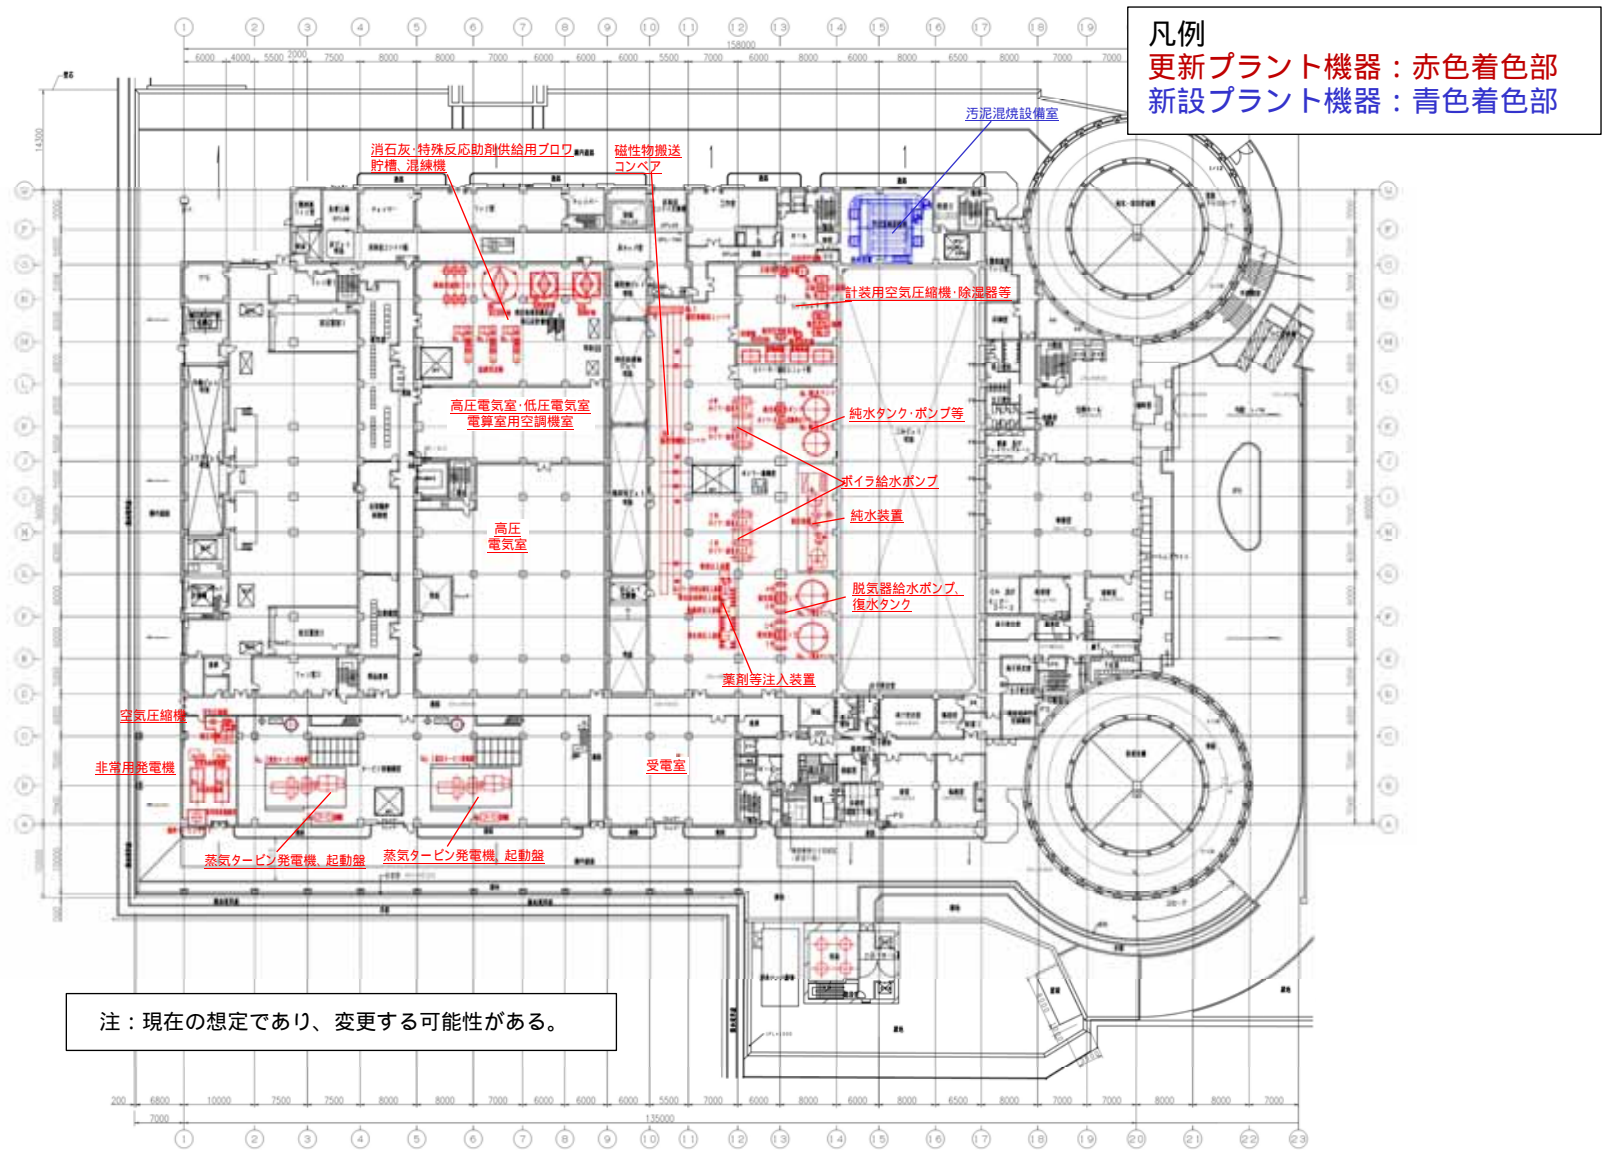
(2) 設備機器の更新箇所（2階平面図）
